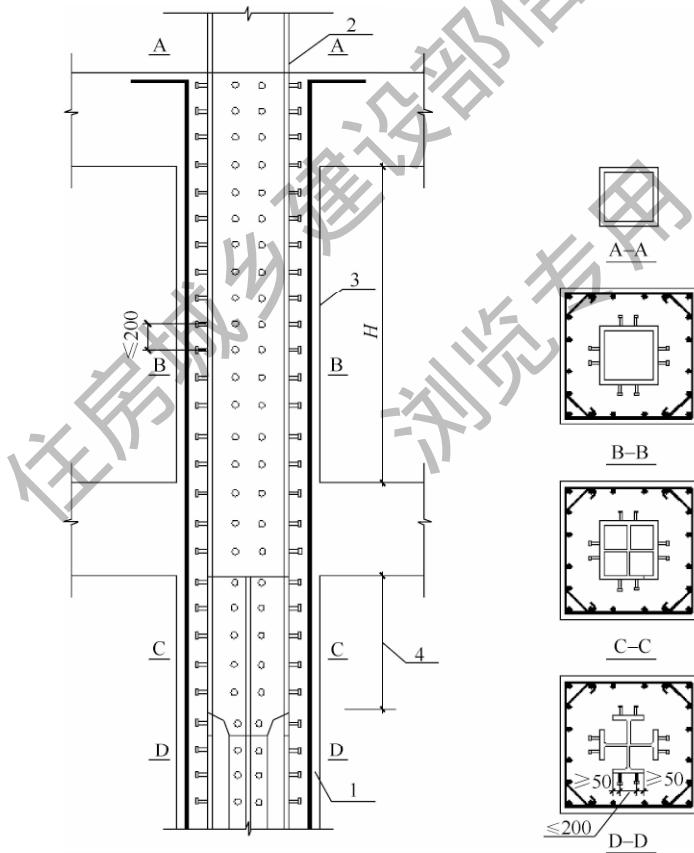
型钢混凝土柱与钢柱的过渡层连接构造
